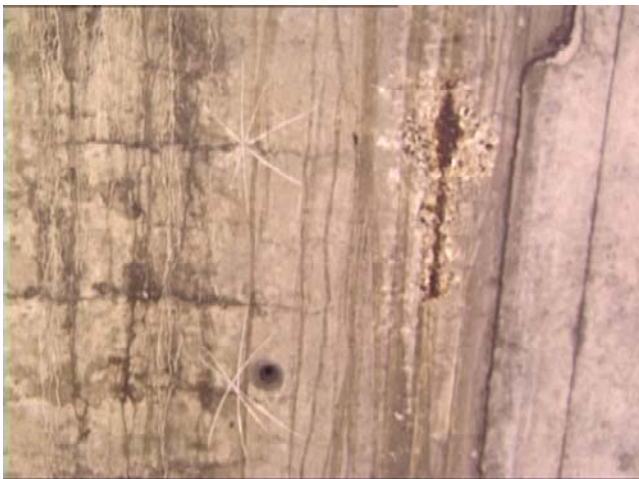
Eclatement de béton avec armature verticale apparente corrodée, dû vraisemblablement à une insuffisance d'enrobage
